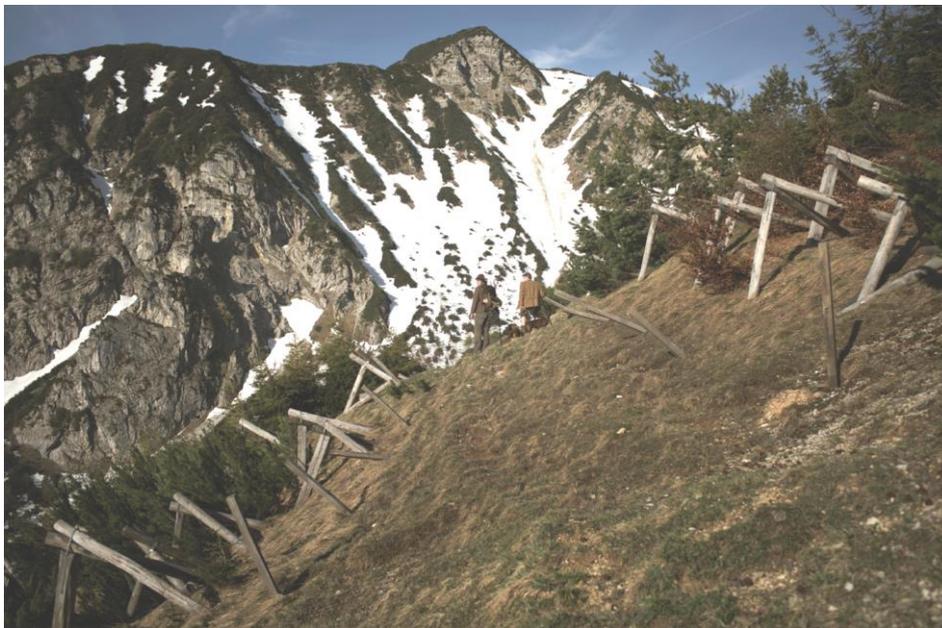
Sanierungsfläche auf der Wuhsteinalm bei Schleching. Bildautor: Ziegler, Matthias
